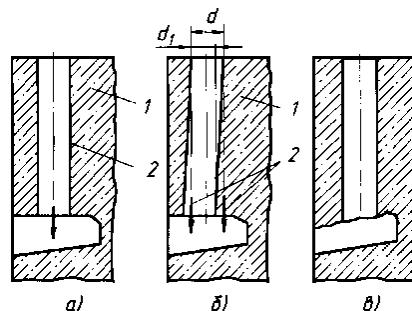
Правильное (а) и неправильное (б; в) выполнение колодцев под фундаментные болты:
